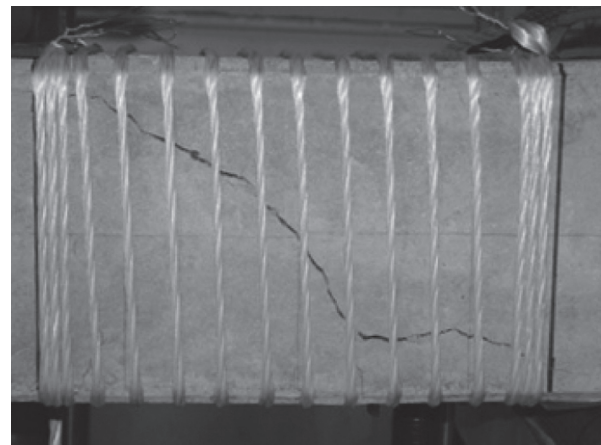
斜めひび割れ状況 (No.6)
